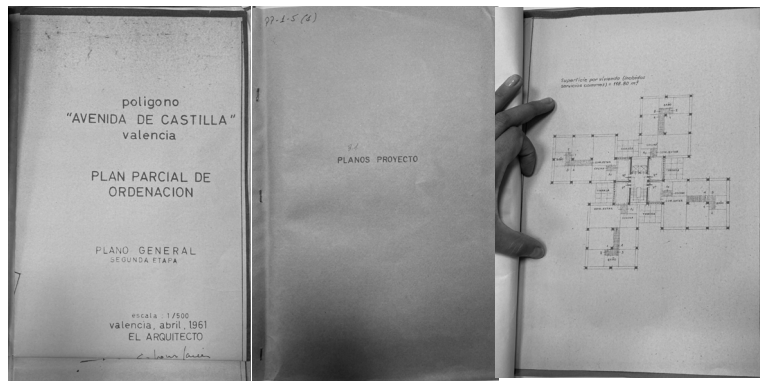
Portada de planos de proyecto. | Planta tipo de una de las tipologías de vivienda del grupo.
